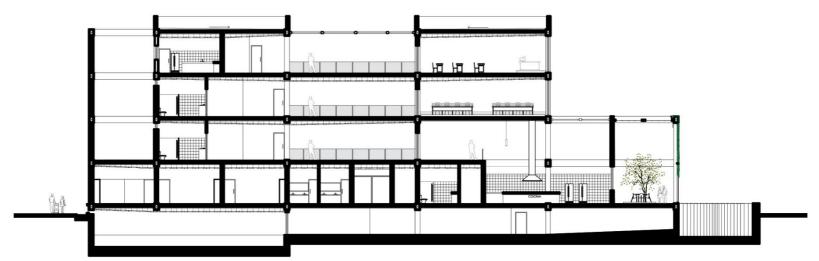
Corte longitudinal 1 Fuente: elaboración propia
